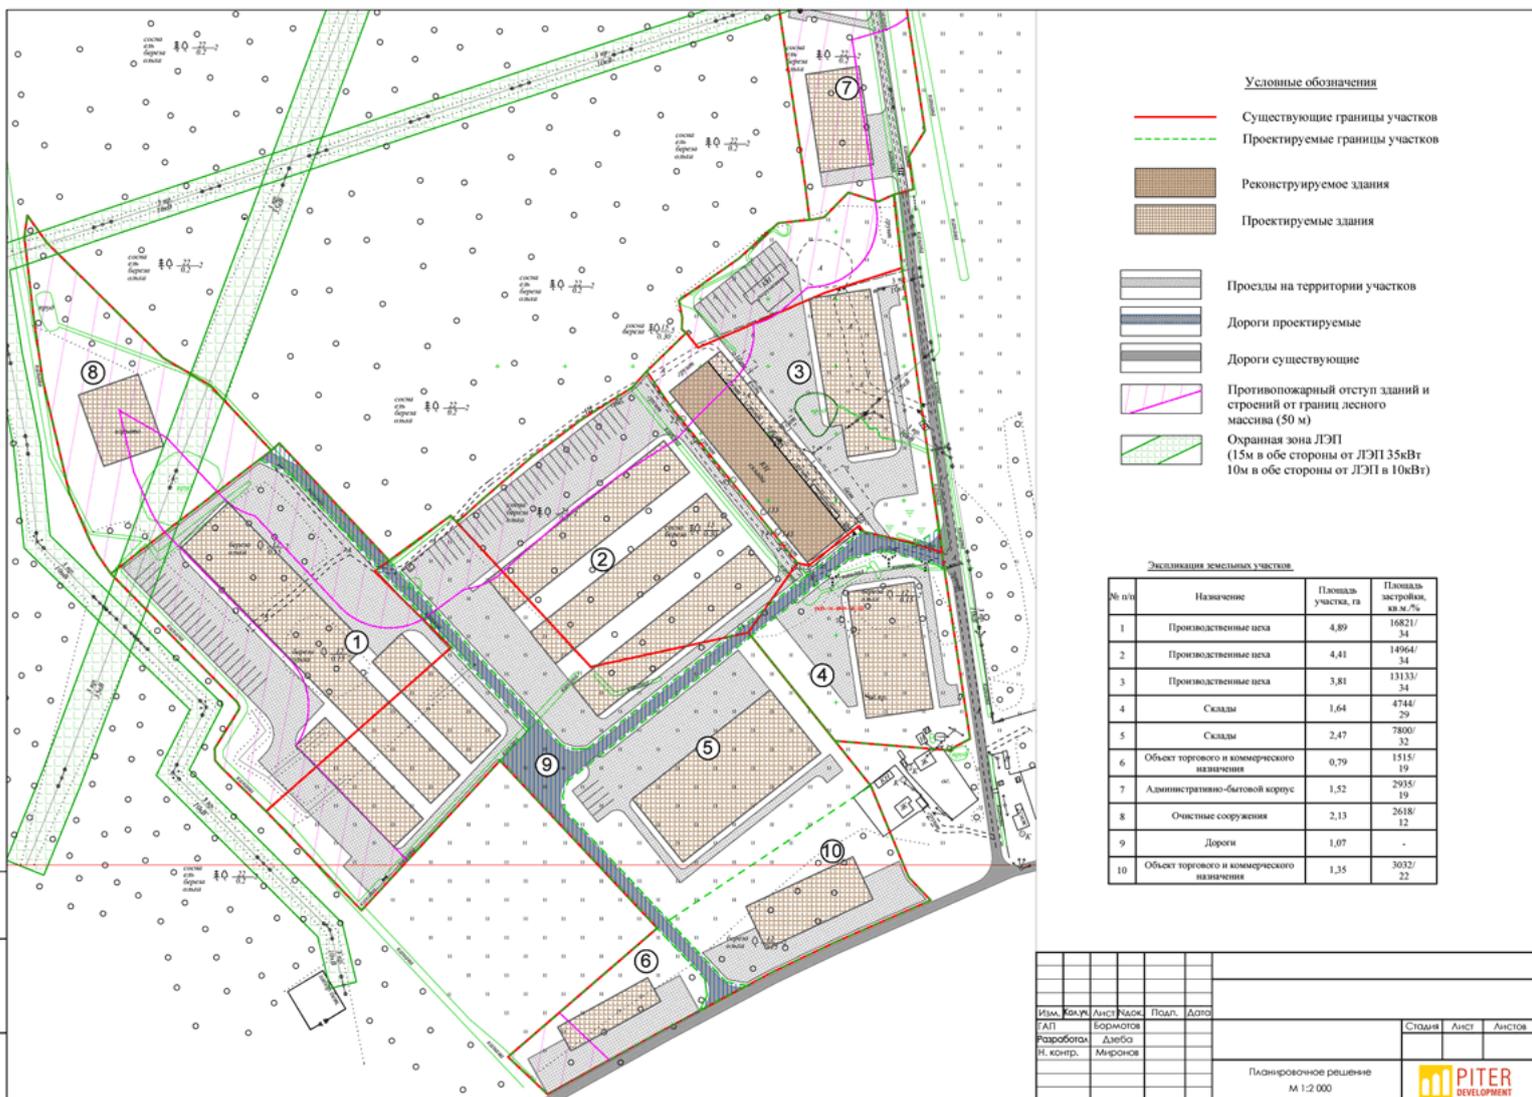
«Генеральный план планируемой промышленной зоны площадью 24 га»
